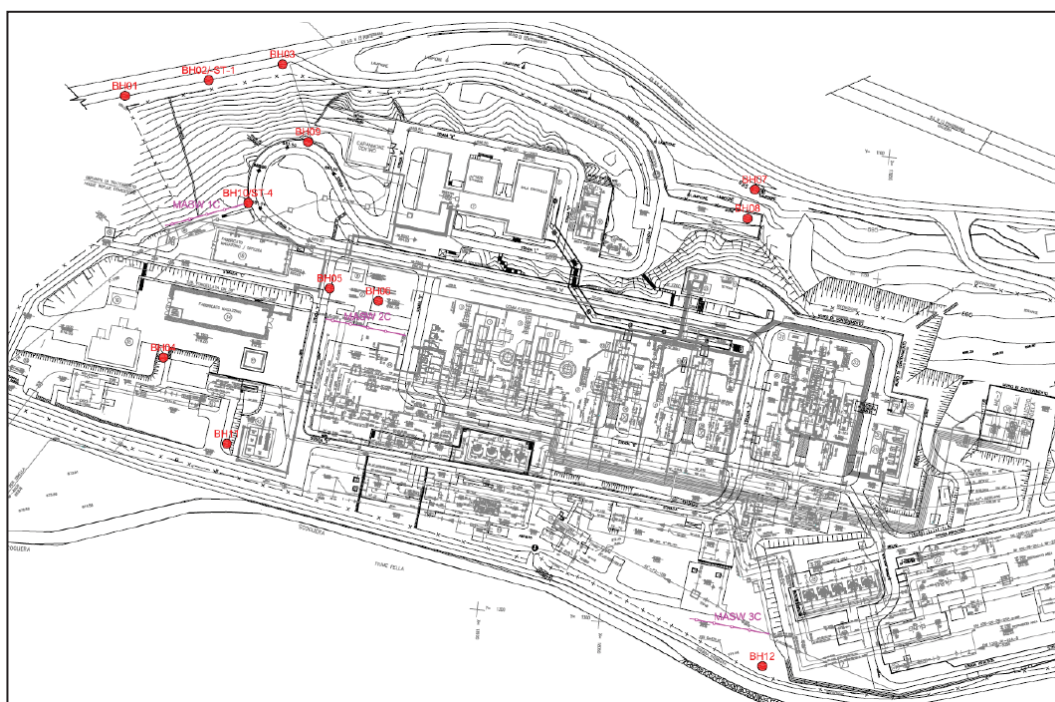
Stralcio planimetrico con ubicazione delle indagini svolte
